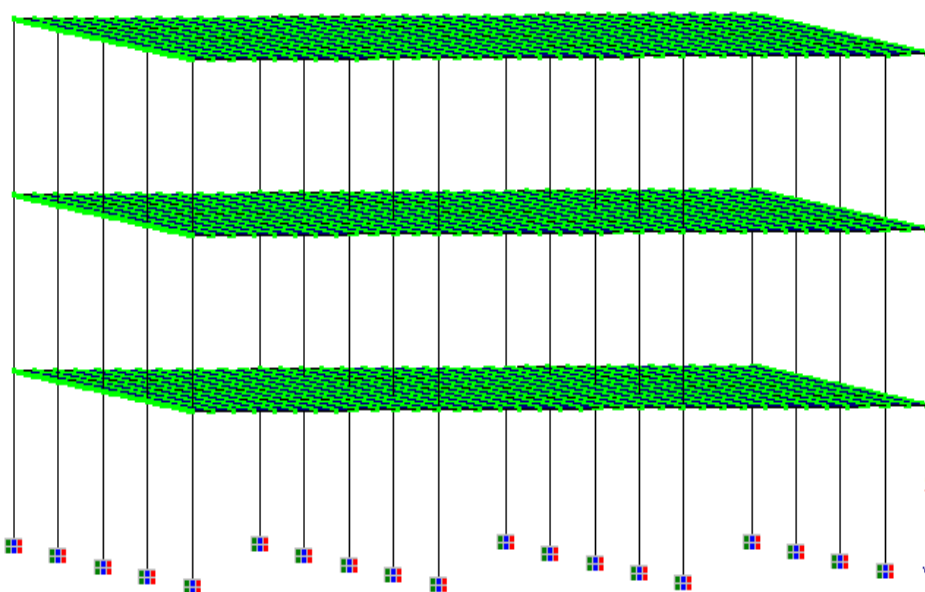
Schéma illustratif du modèle d'étude du bâtiment avec planchers en hourdis à 3 niveaux avec un chargement vertical sur le poteau d'angle
